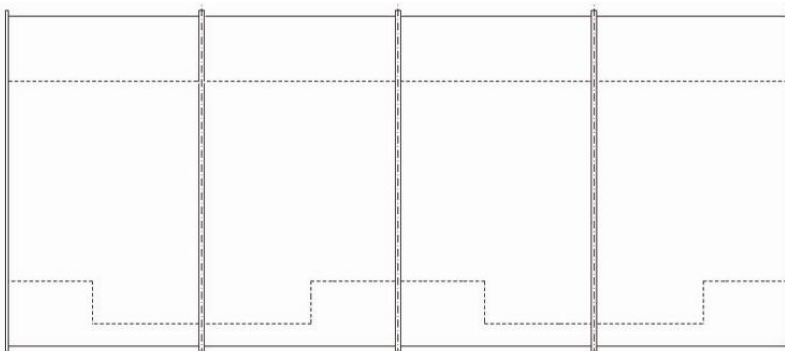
Planta de cobertura das quatro unidades em nível. Fonte: Construpex (2009)
